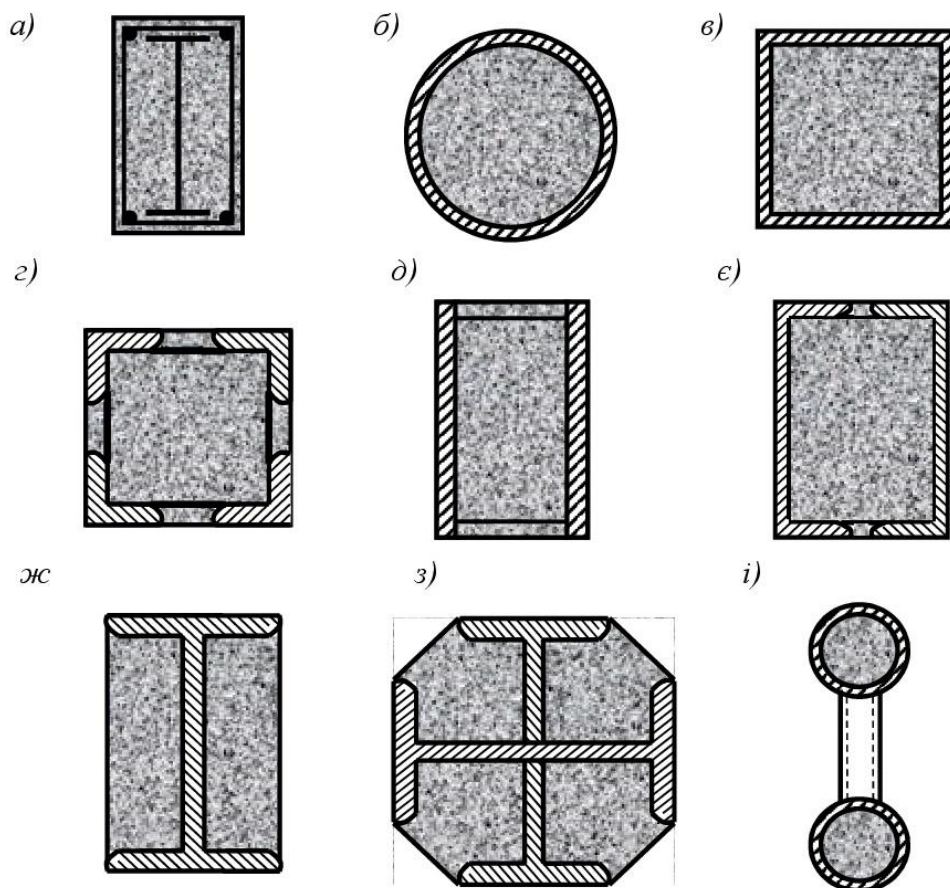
Поперечні перерізи сталезалізобетонних колон:
